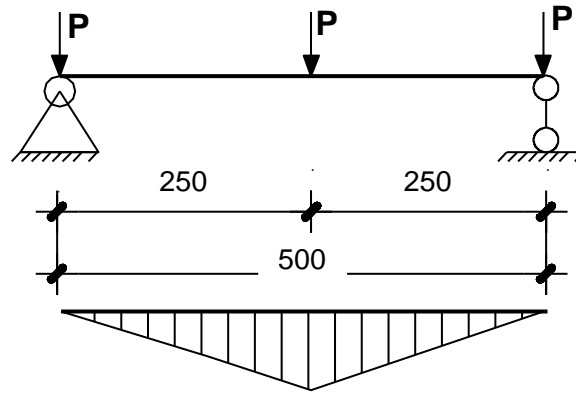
Sơ đồ tính sườn ngang (5)
